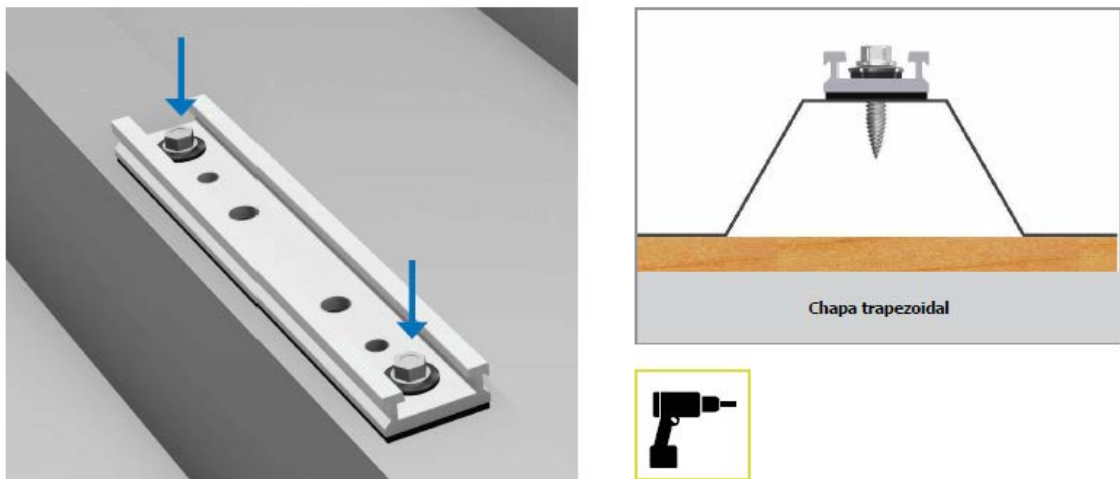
Detalle y perfil de enclavamiento de soporte
